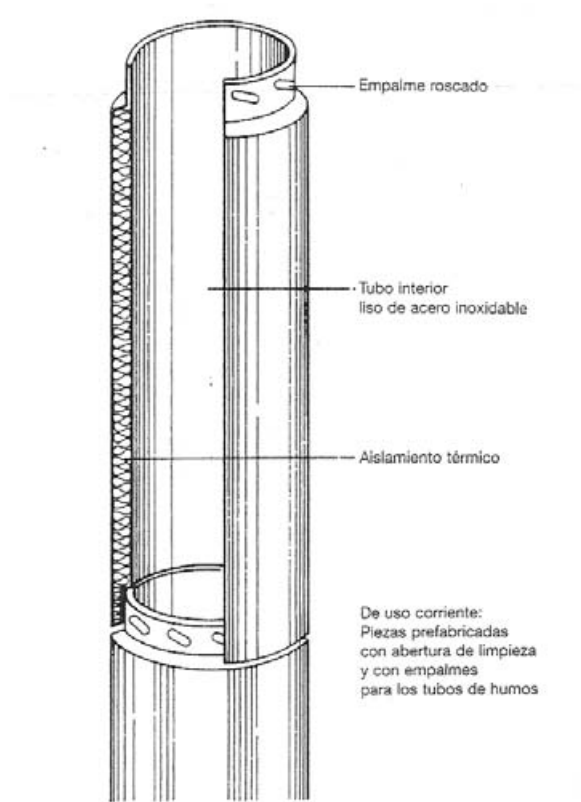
Chimenea de pared doble de acero inoxidable, piezas prefabricadas roscadas a prueba de gases.
